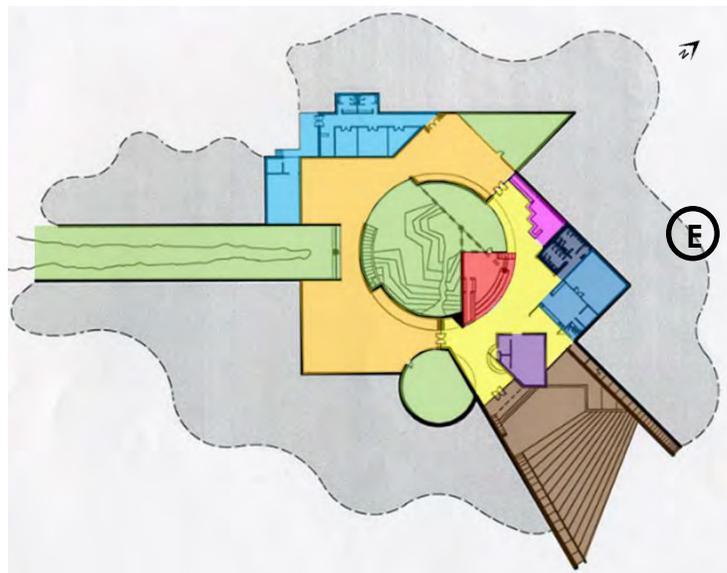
Planta baja del Museo de las Culturas del Norte.
